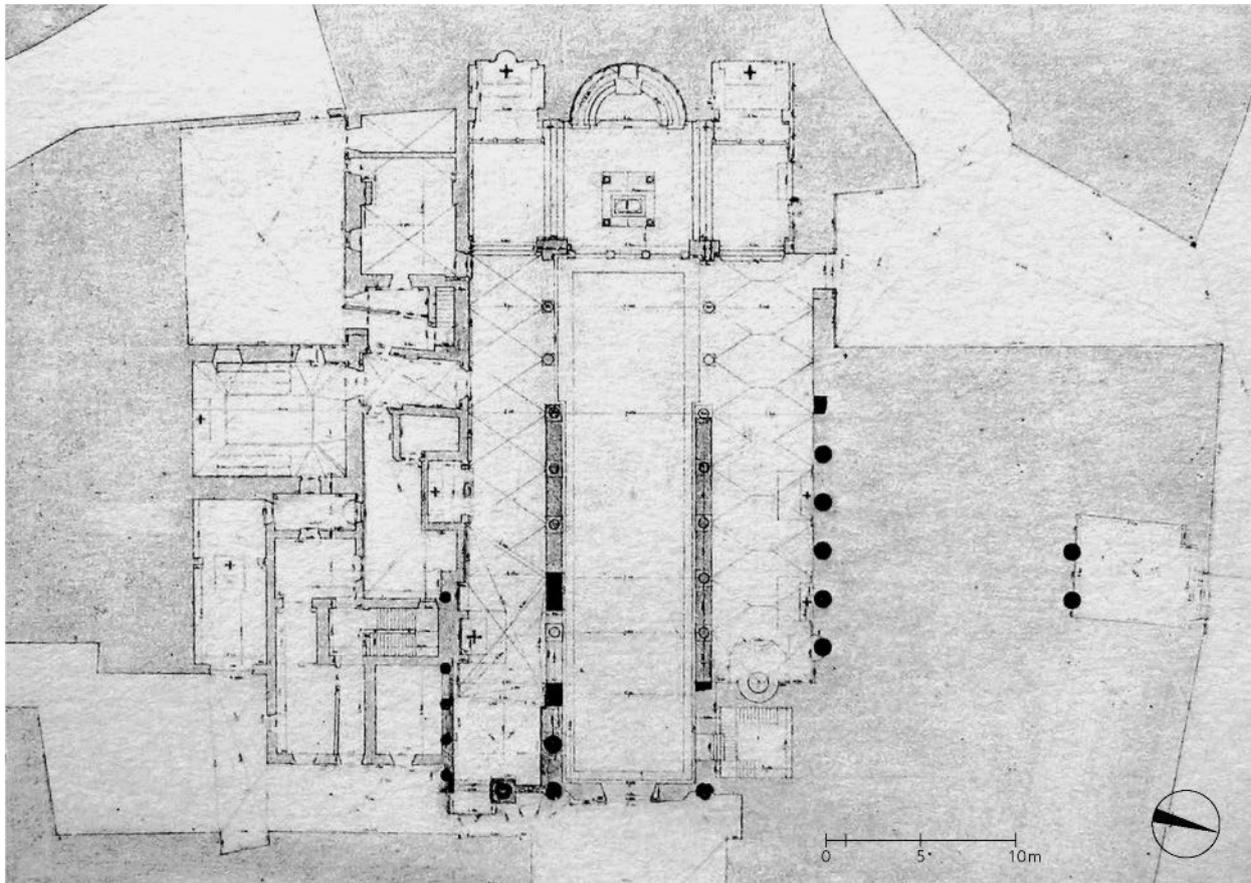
Hector Lefuel, Grundrissplan von S. Nicola in Carcere und umgebenden Gebäuden, 1843 (D'Espouy 1843)
